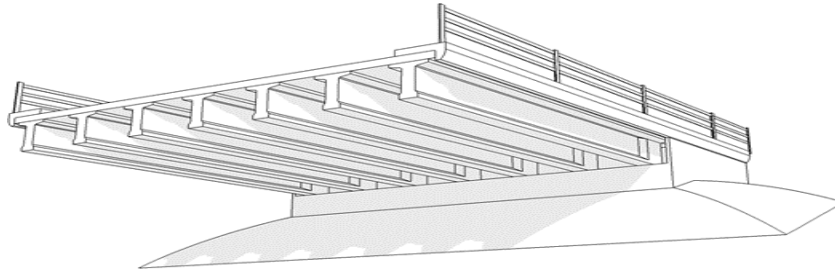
Morphologie d'un pont à poutres en béton précontraint
